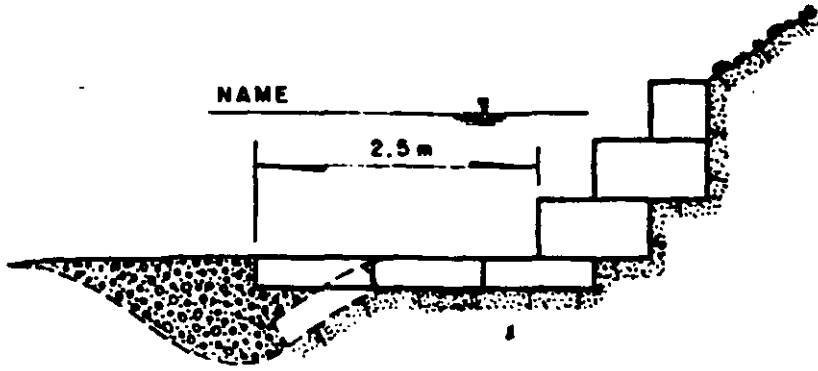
Defensa marginal cimentada sobre una platea [3]
